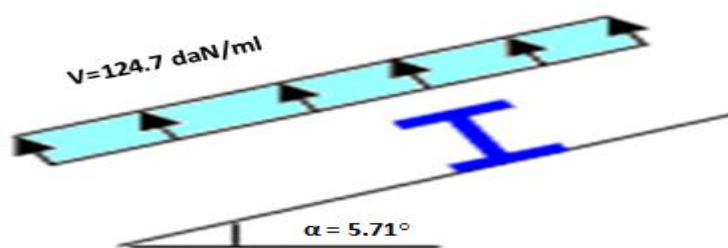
Charge du vent de soulèvement au niveau de la toiture
